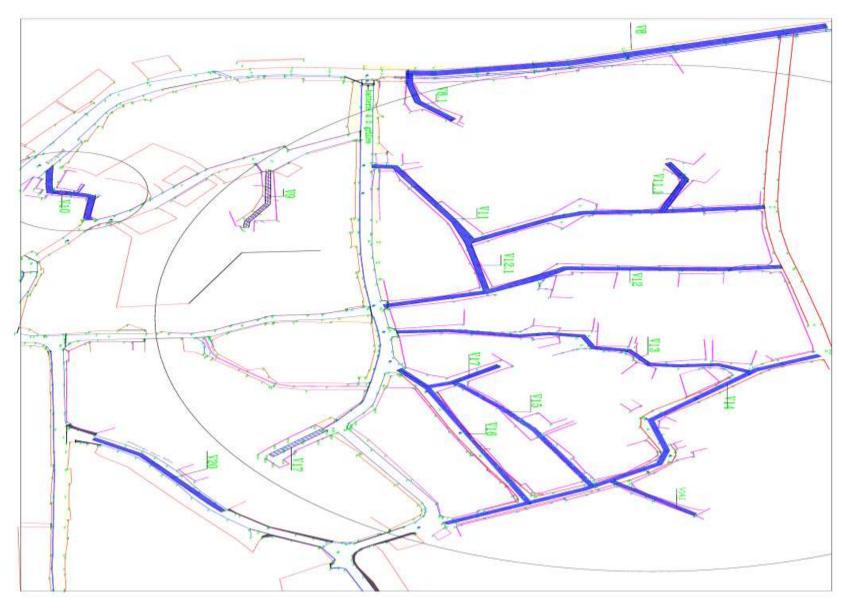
Les interventions programmées sur la voirie dans la zone d'intervention
